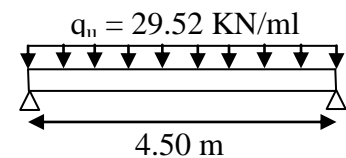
Schéma statique de la poutre de chaînage 3
